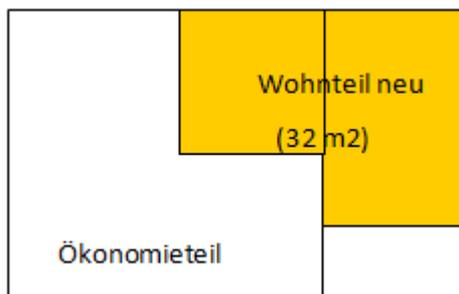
Grundriss bestehendes Maiensäss mit Ausbaumöglichkeit
